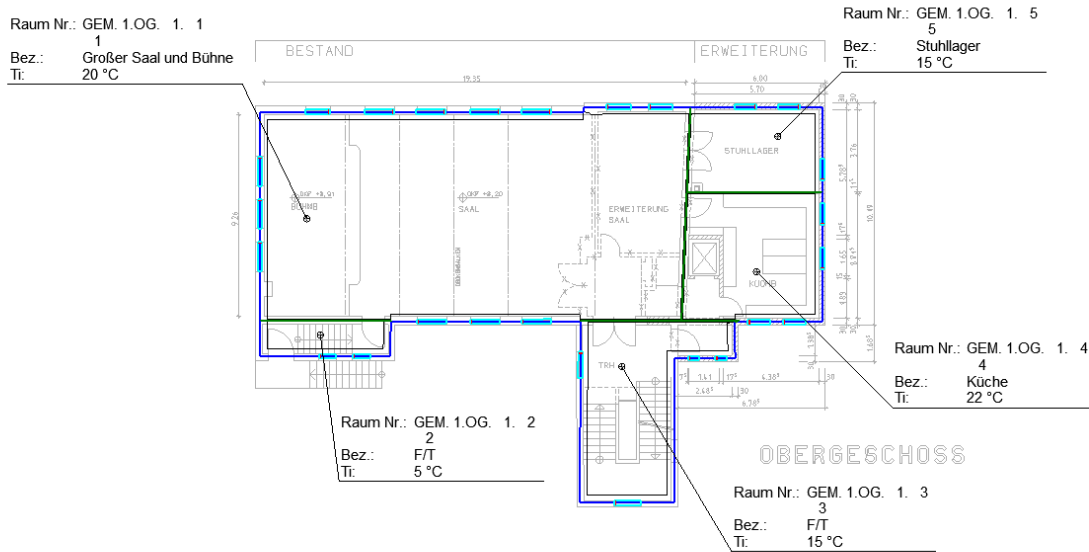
Plan Obergeschoss Gemeindehaus (erstellt mit mh-Software)
